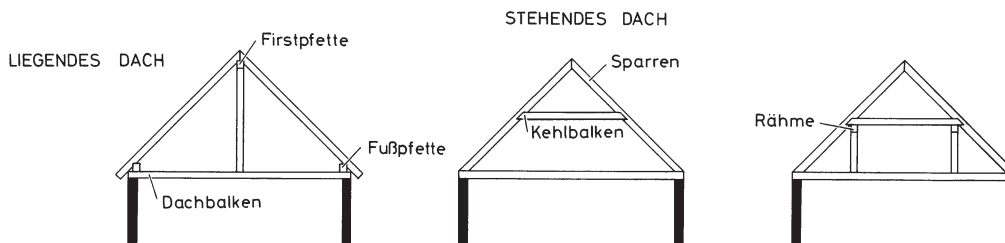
Schematische Darstellung einzelner Dachstuhlkonstruktionen. Links: Rofendach mit abgefangener Firstsäule, Mitte: Sparrendach mit Kehlbalkenaussteifung, Rechts: Sparrendach mit doppeltem, stehendem Stuhl (nach BECK 1984, 123, Abb. 5).
